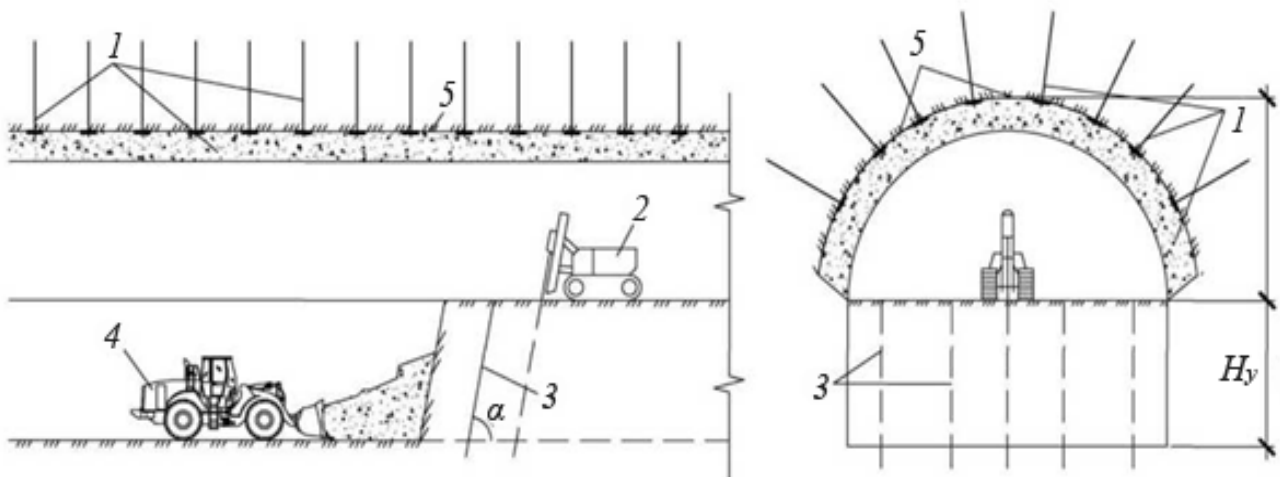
Буріння круто нахилених свердловин верстатом на уступі:
